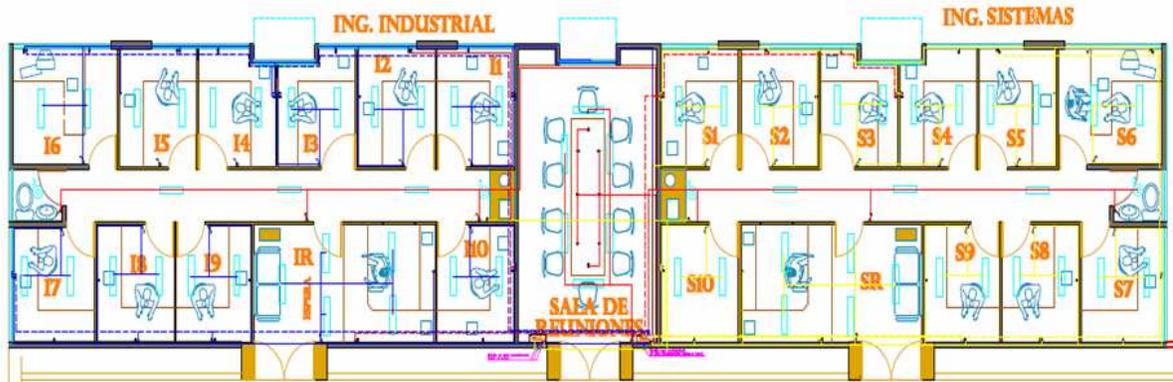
Plano de planta de las oficinas de Sala de Profesores
